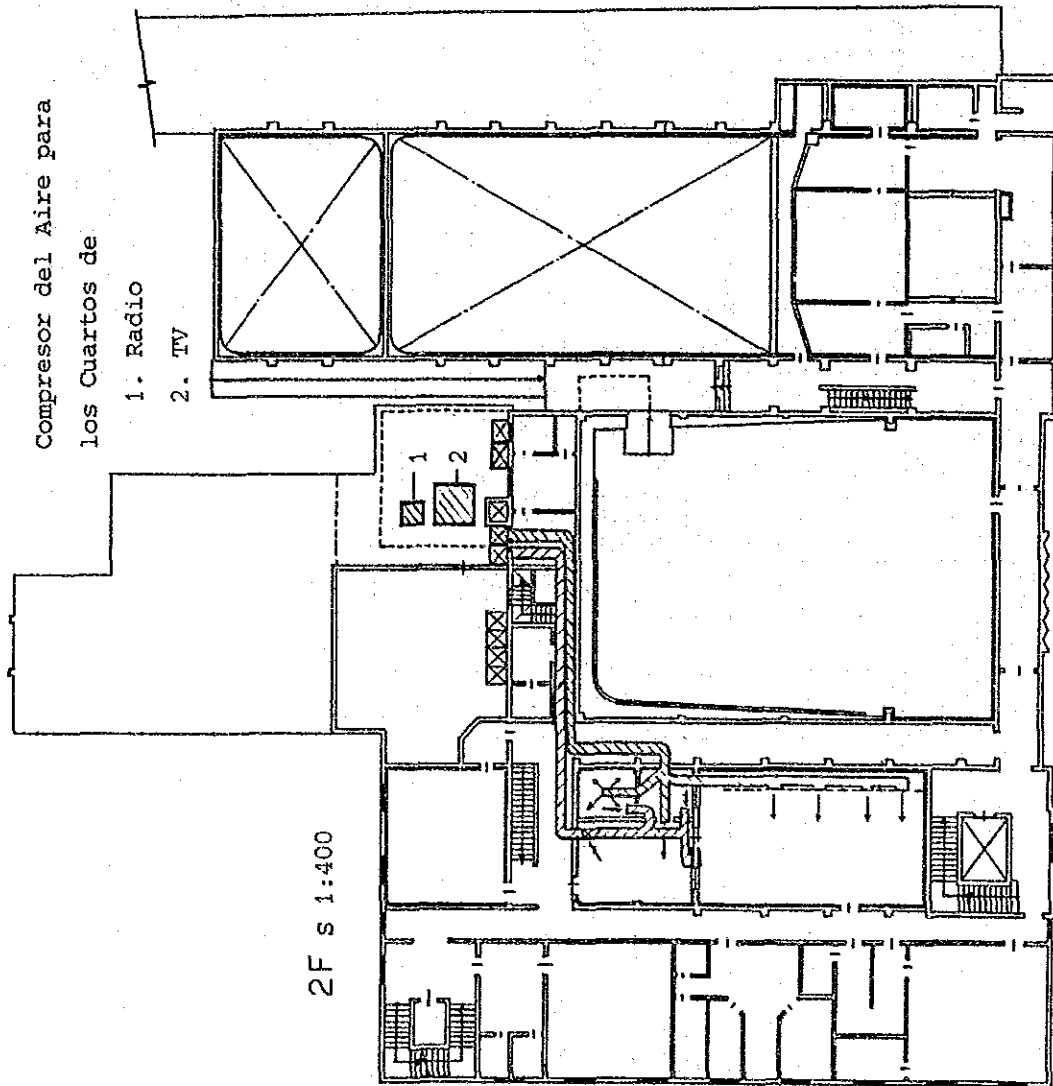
Plano del Aire Acondicionado (Segundo Piso)
